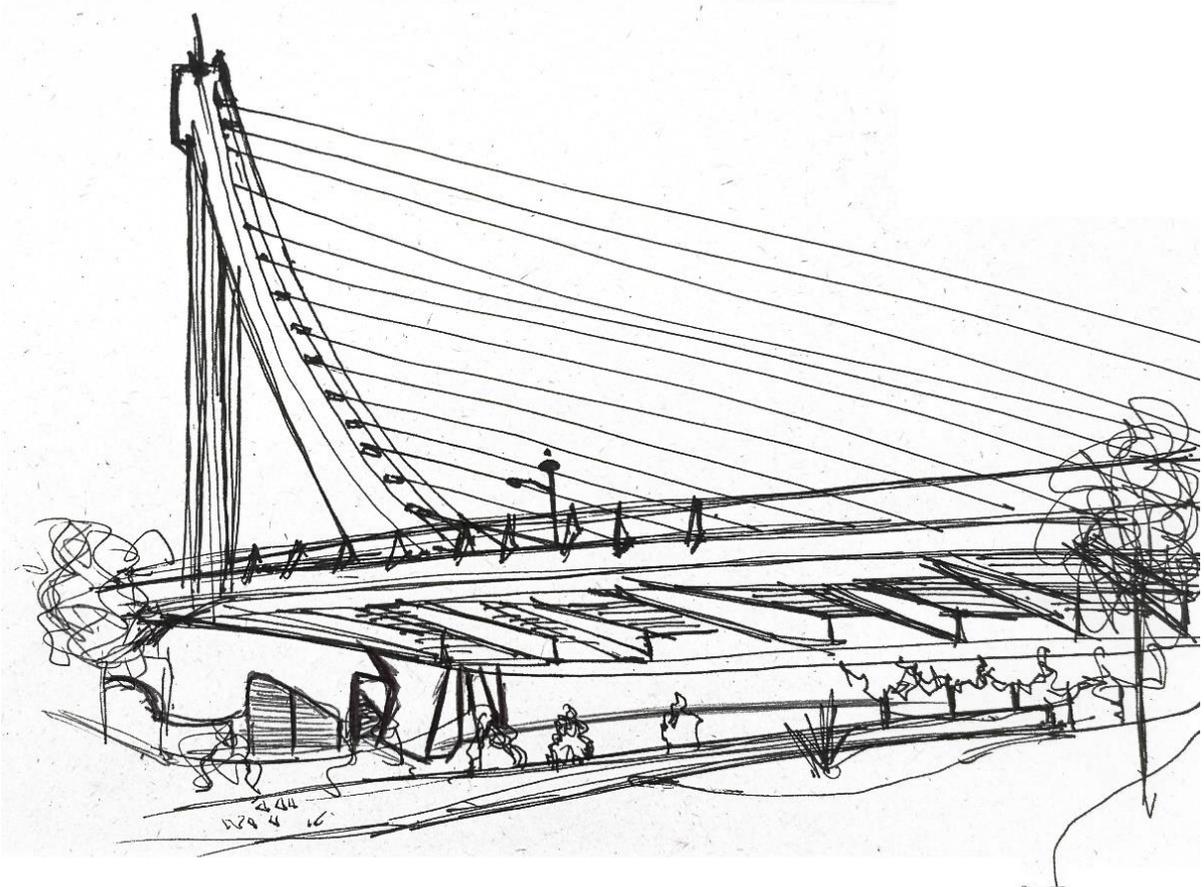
Puente Azud del Oro (Puente de Serrería)
